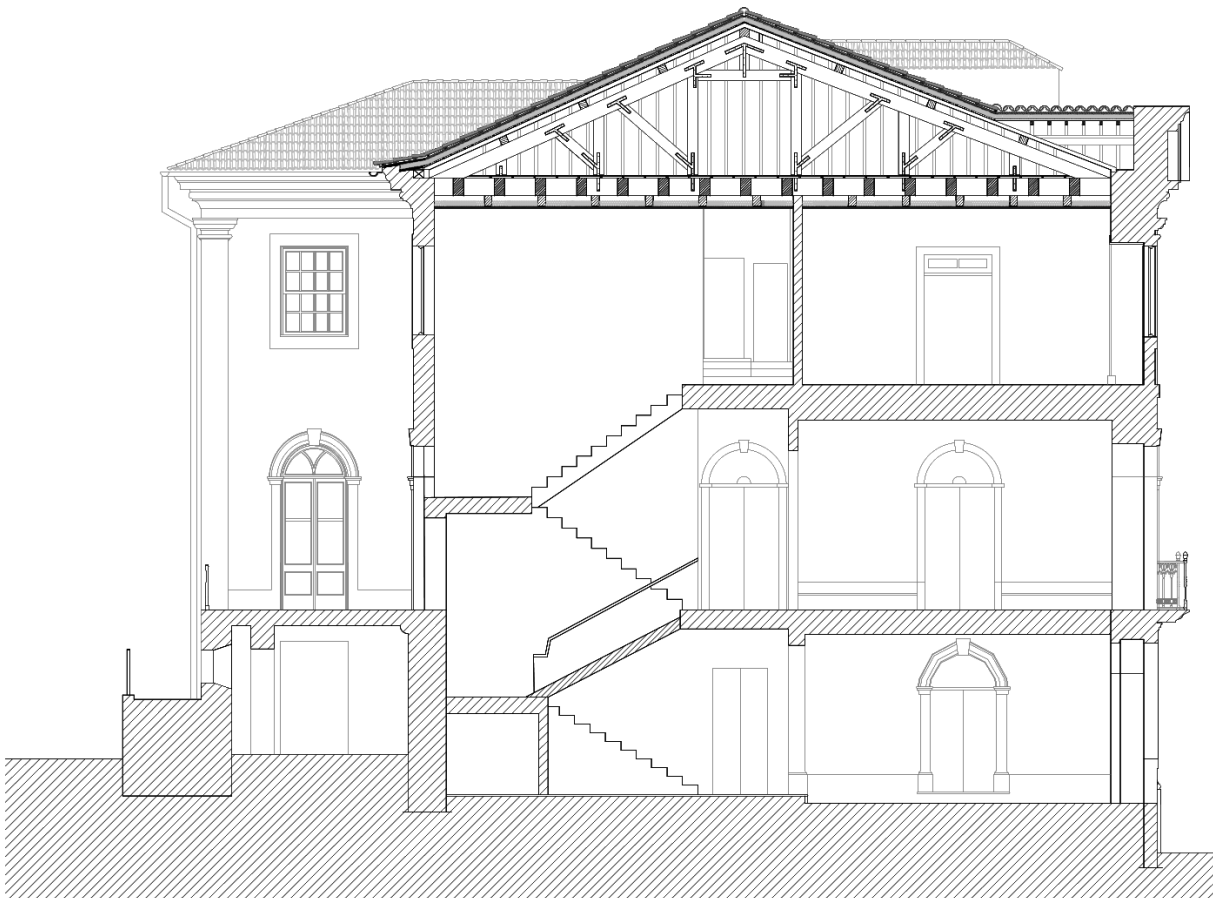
Corte transversal da cobertura em madeira proposta para a Casa Martins Sarmento;
